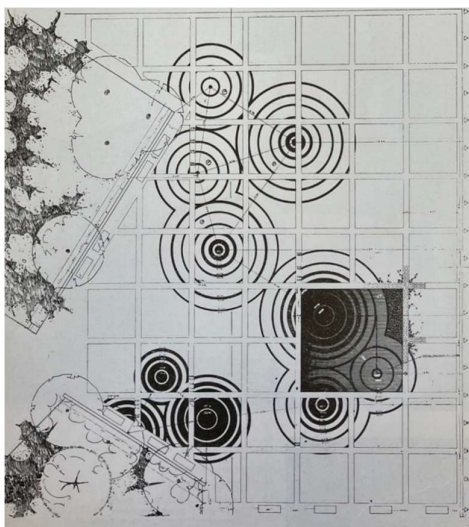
Planta da Praça Álvaro Ponce Dentinho em Olivais Norte da autoria do Arquiteto paisagista Álvaro Dentinho retirada do artigo Arranjos dos espaços exteriores na Revista Arquitetura nº81, pág.17 Consultado em 08/06/2025.
